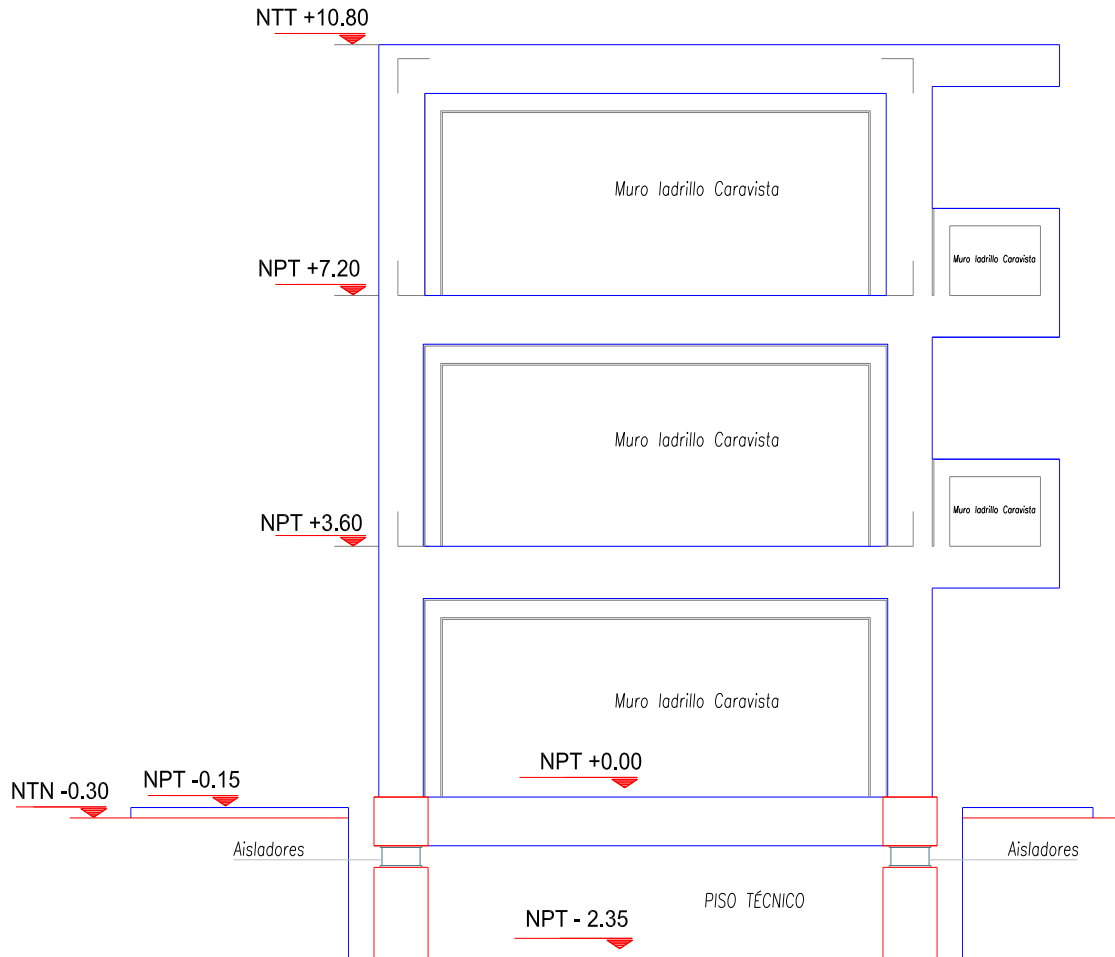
c. Elevación Lateral y piso de técnico edificio aislado.
